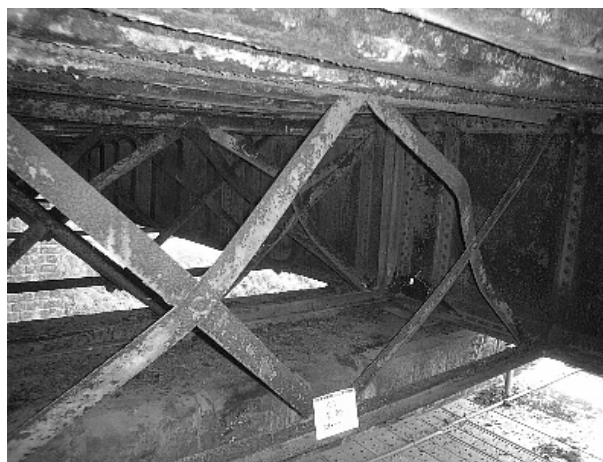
対傾構変形状況(P1 橋脚側)
